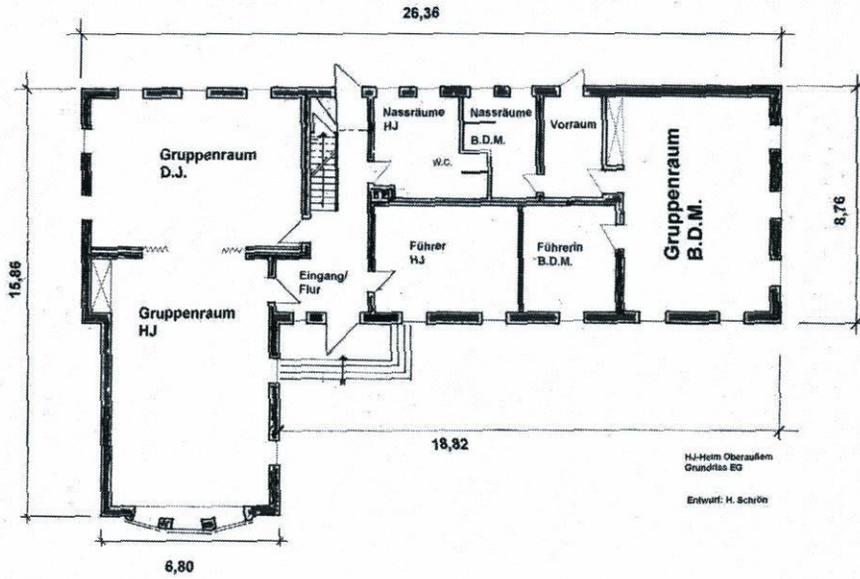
HJ-Heim Oberaußem, Grundriss Erdgeschoss. (Bearb. H. Schrön).
